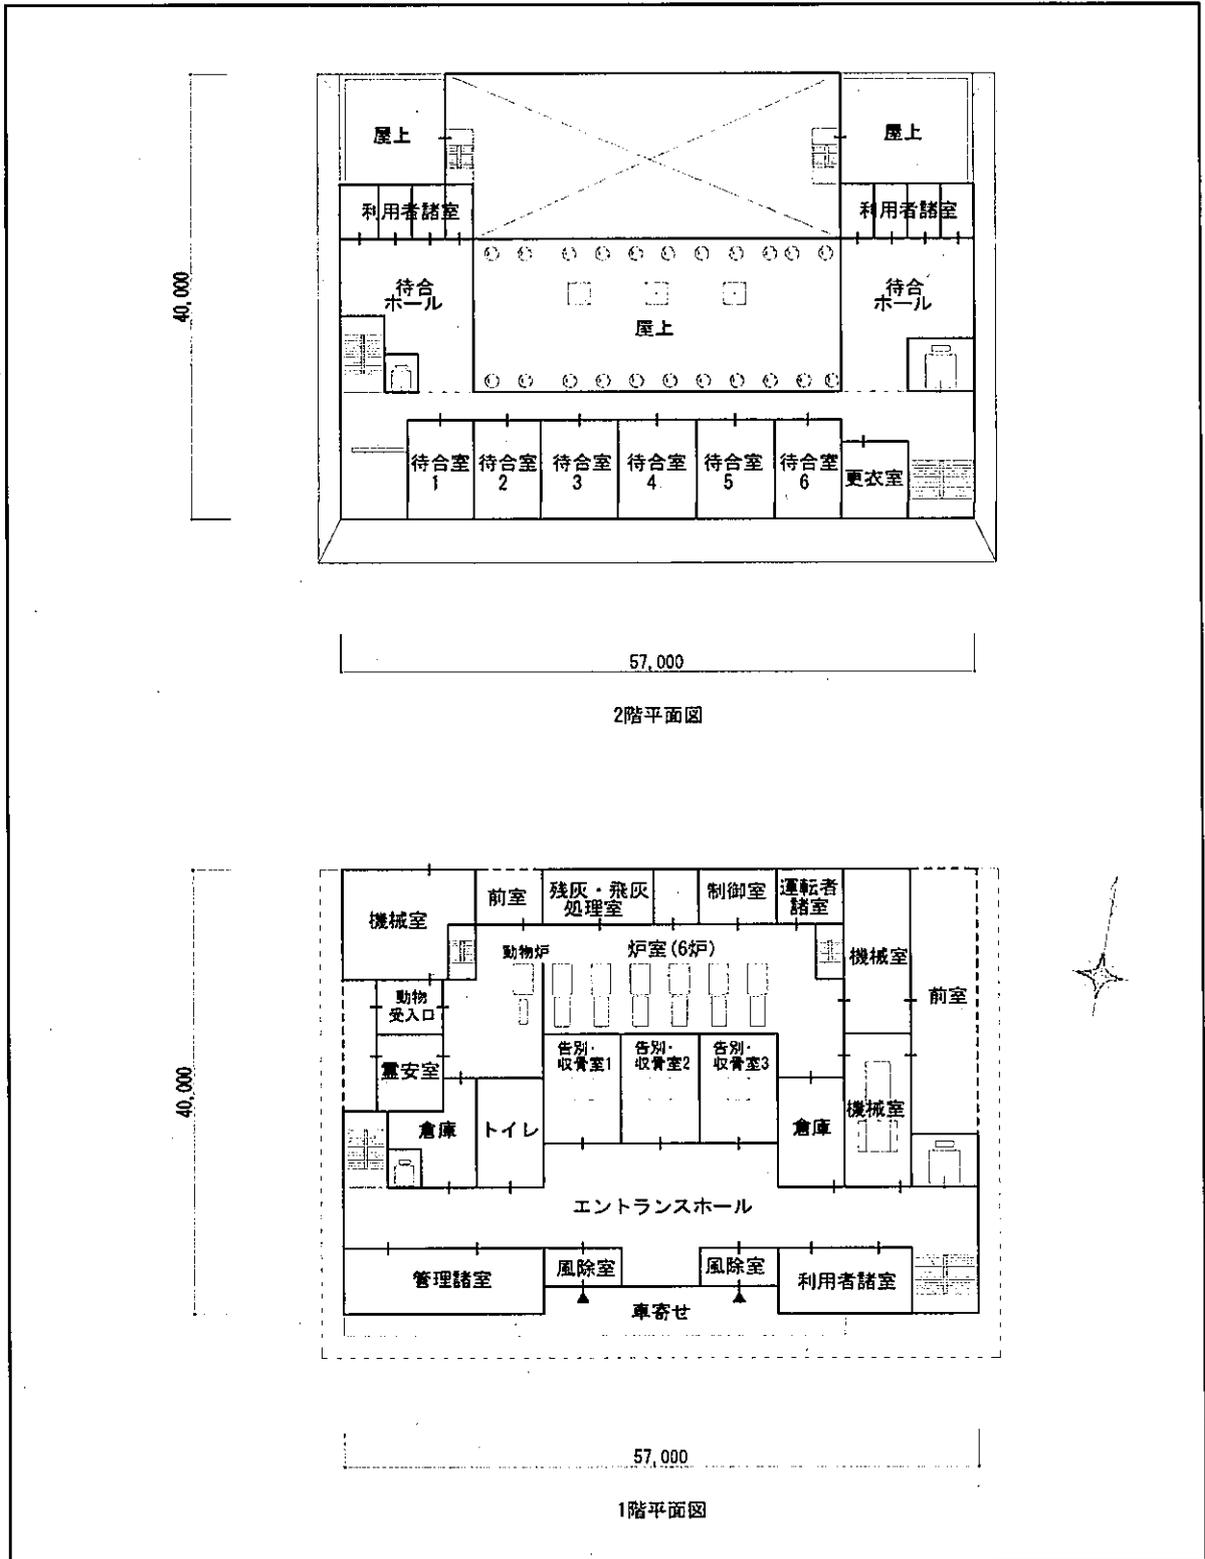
草津市単独整備(2.5 件/基・日) モデルプラン平面図
